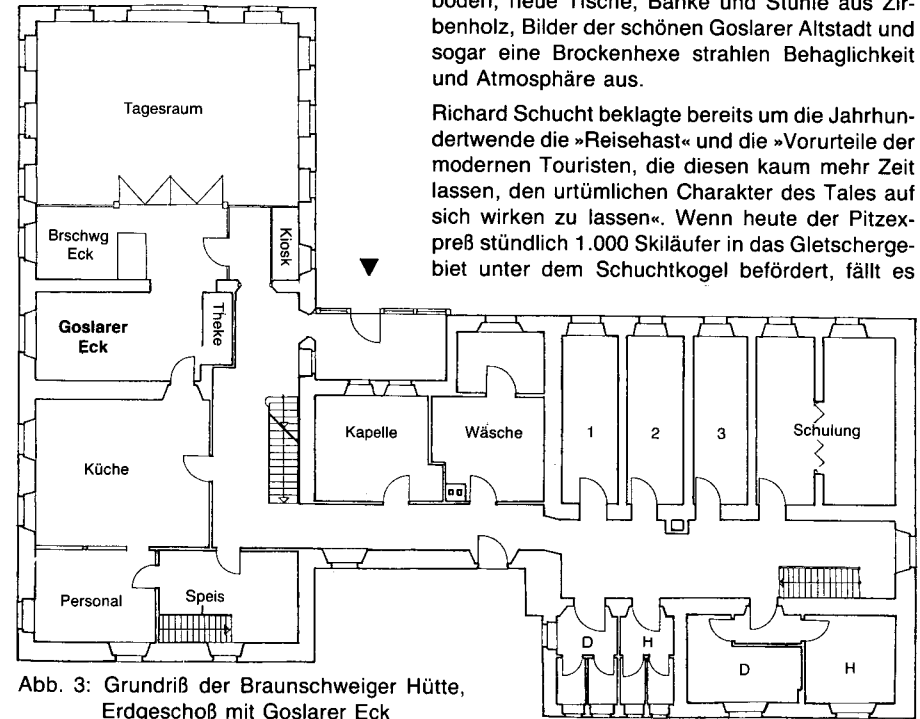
Grundriß der Braunschweiger Hütte, Erdgeschoß mit Goslarer Eck
